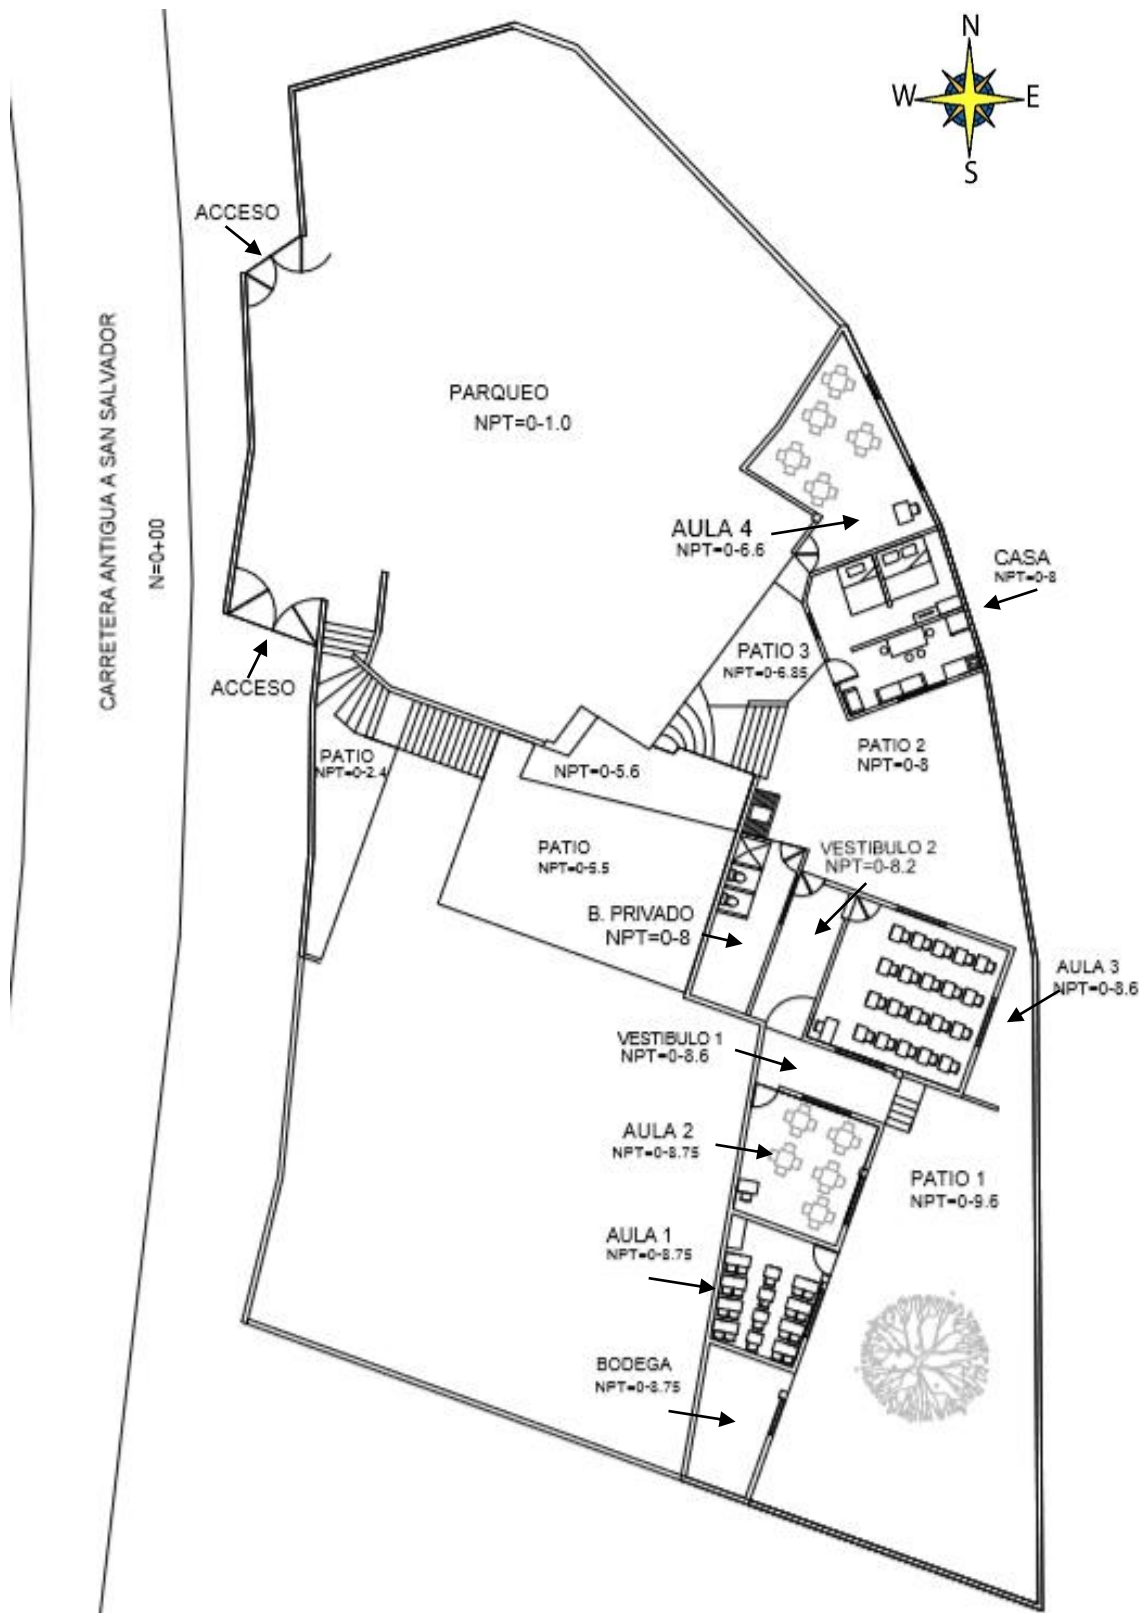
Plano de conjunto y planta arquitectónica baja primer nivel.
